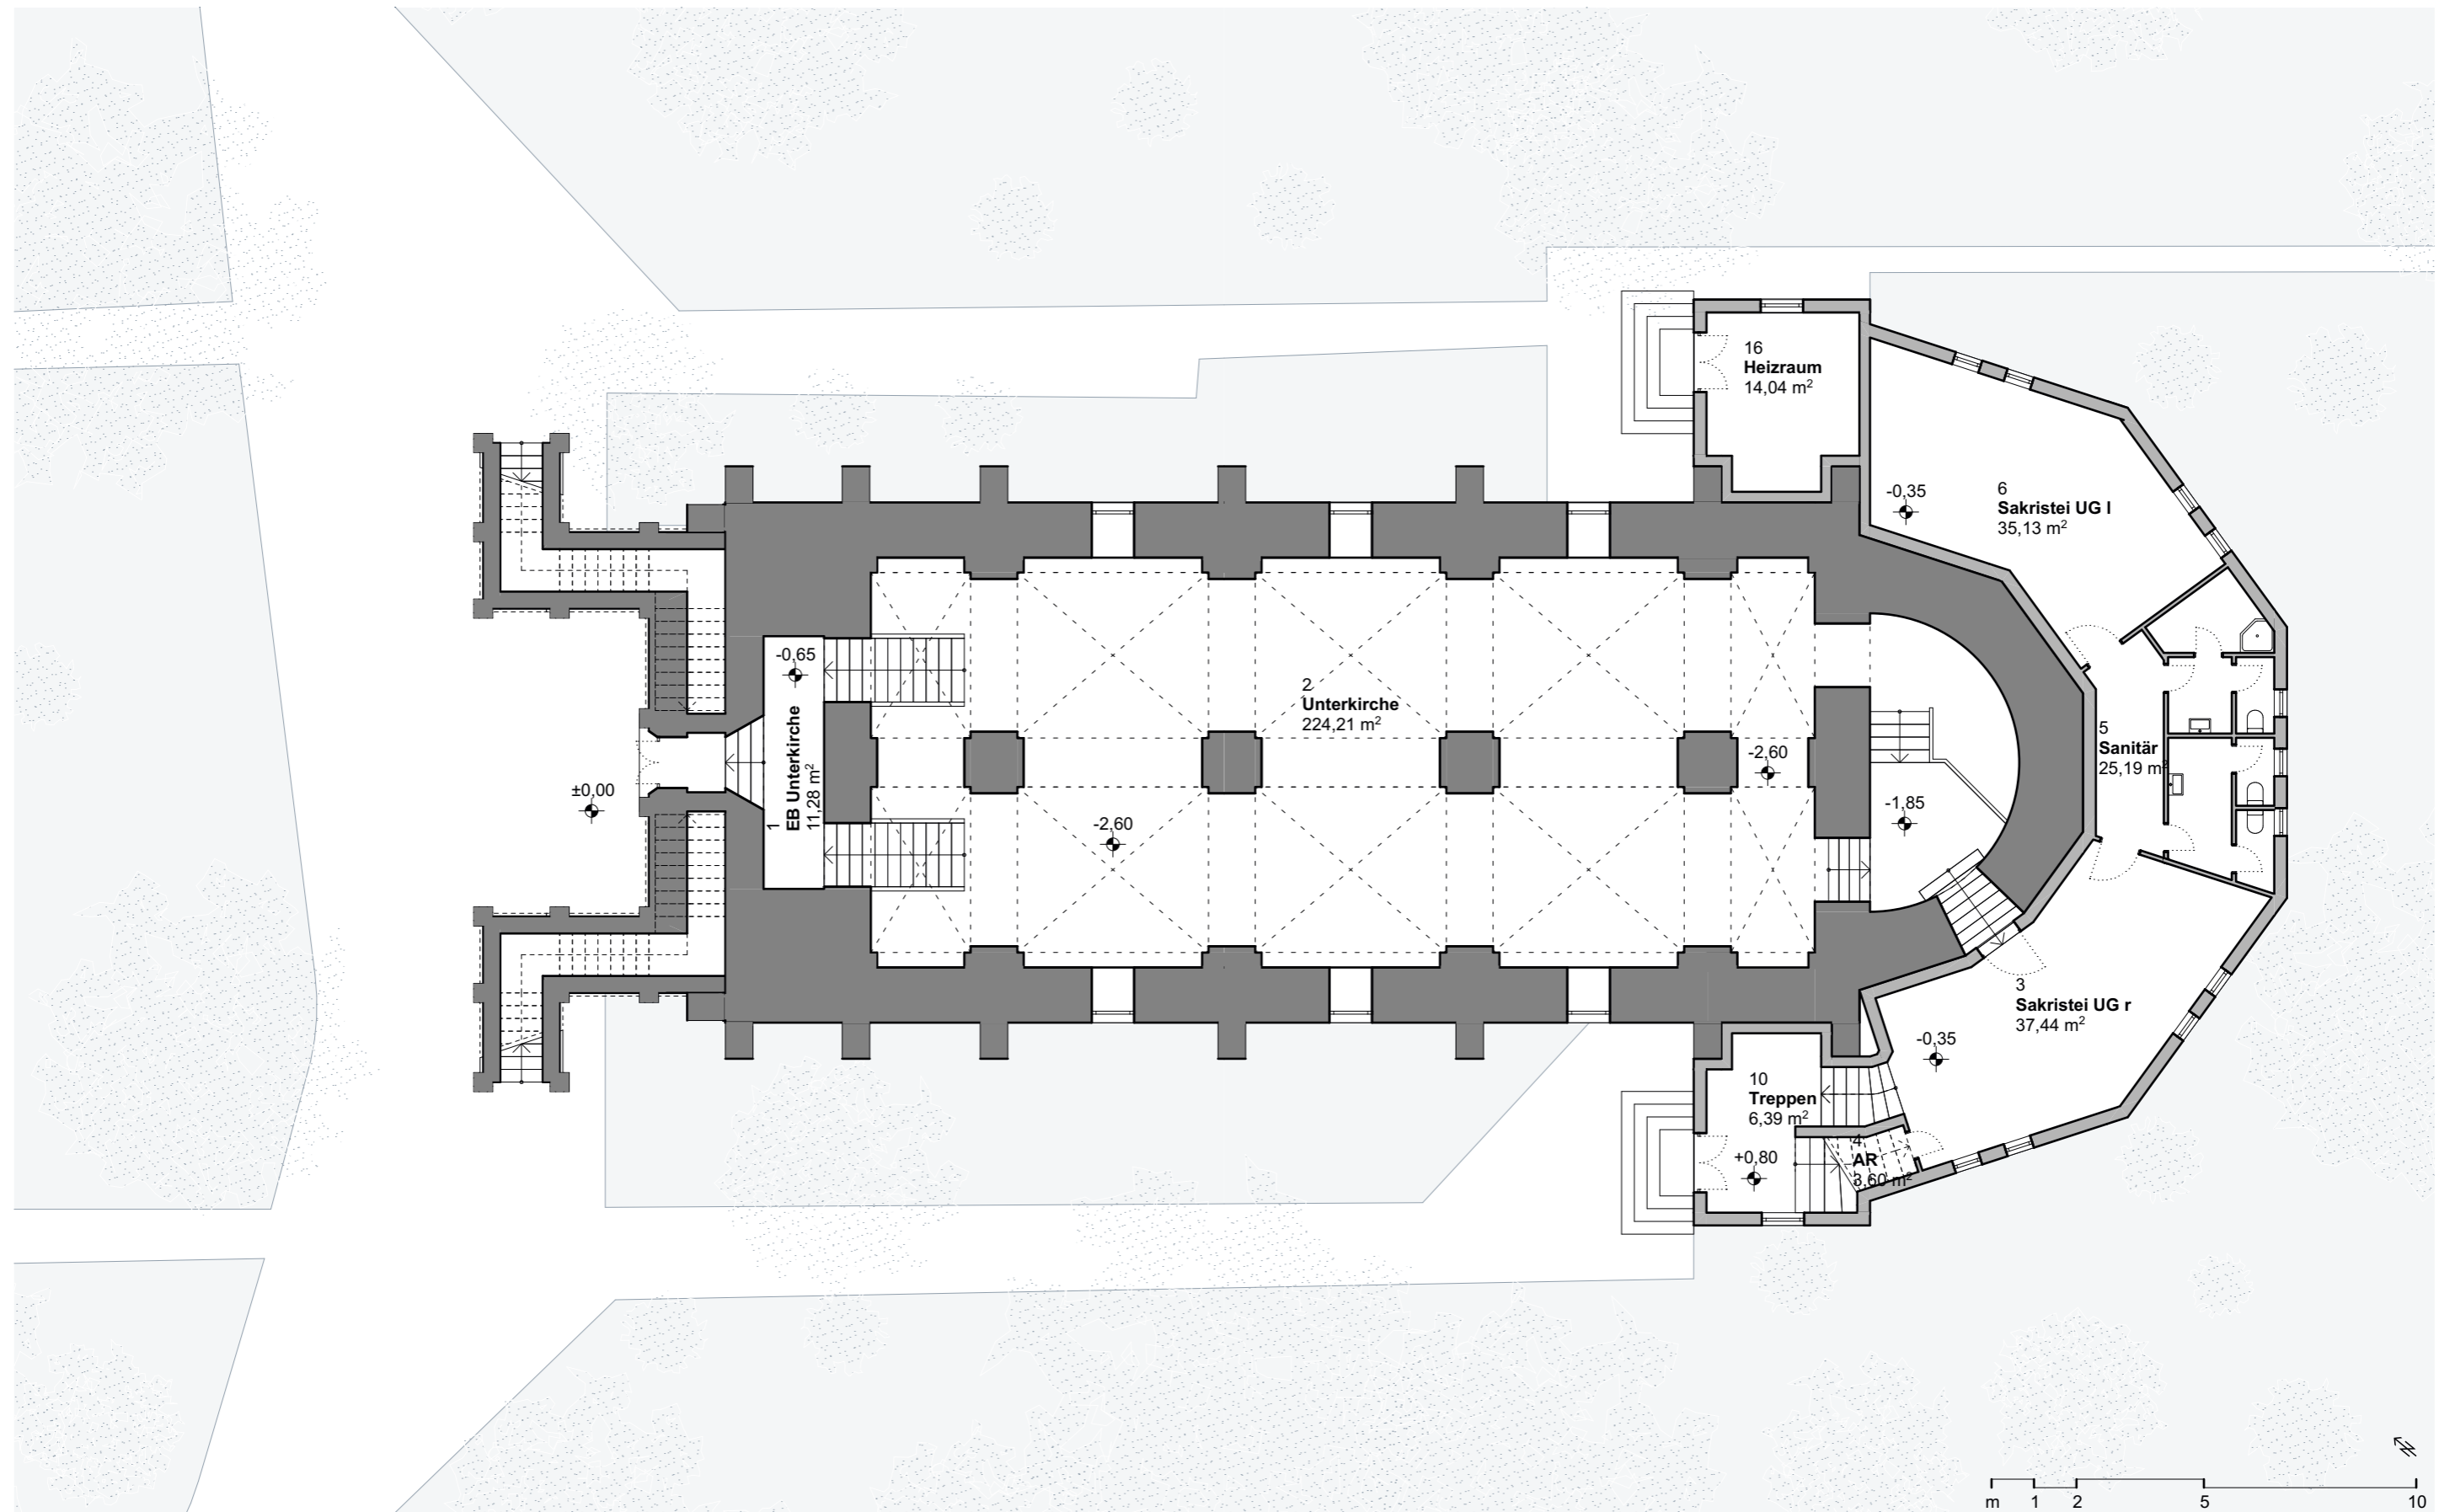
Bestandsplan Arsenalkirche: Unterkirche und Erdgeschoss der Sakristei
